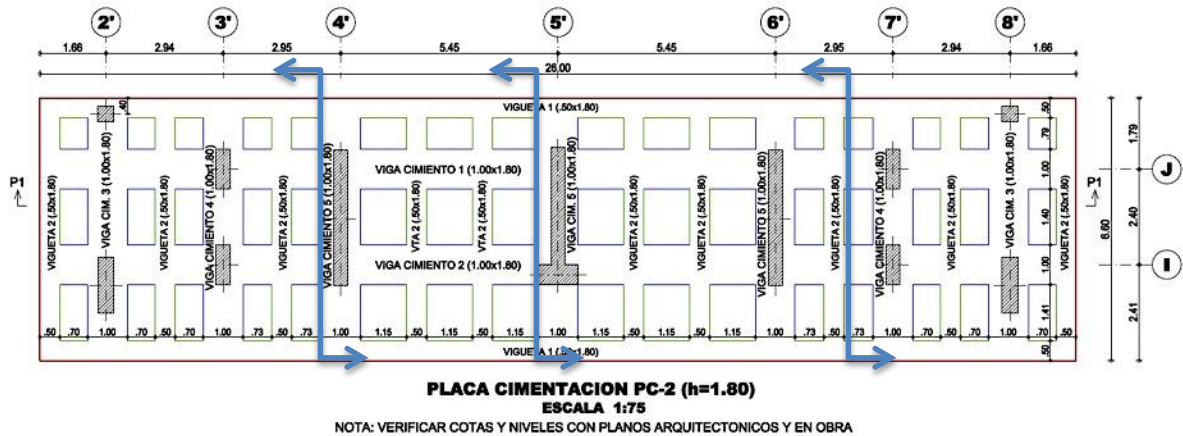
Detalle en planta de losa de cimentación PC-2, columnas y pantallas.
